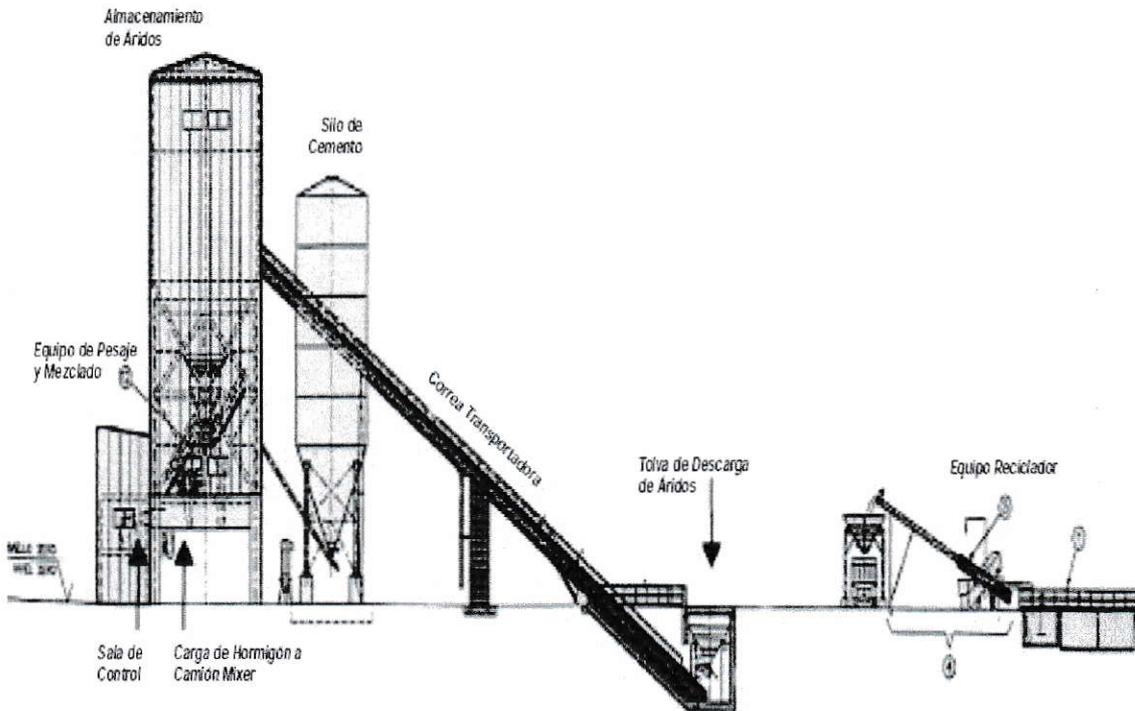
Modelo de Planta “Ecológica” de Hormigón (Departamento Técnico BETONSA S.A. 2000).
